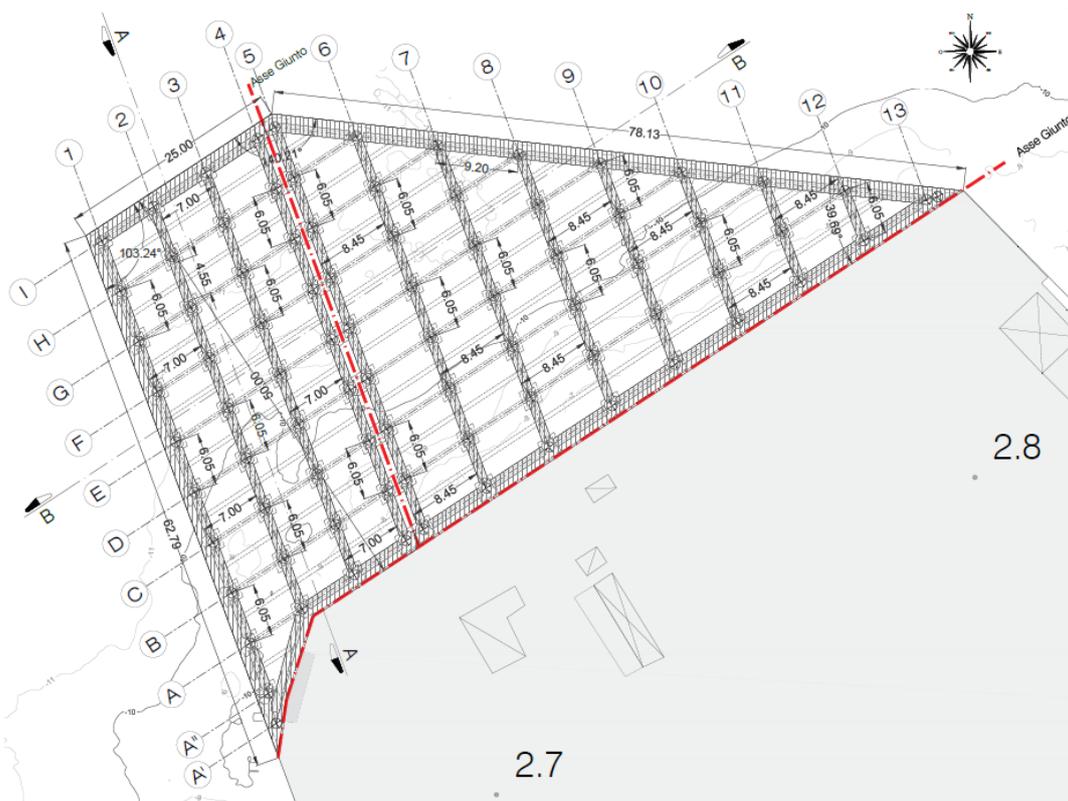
Pianta di progetto a quota +1.00 m con struttura portante dell’impalcato
